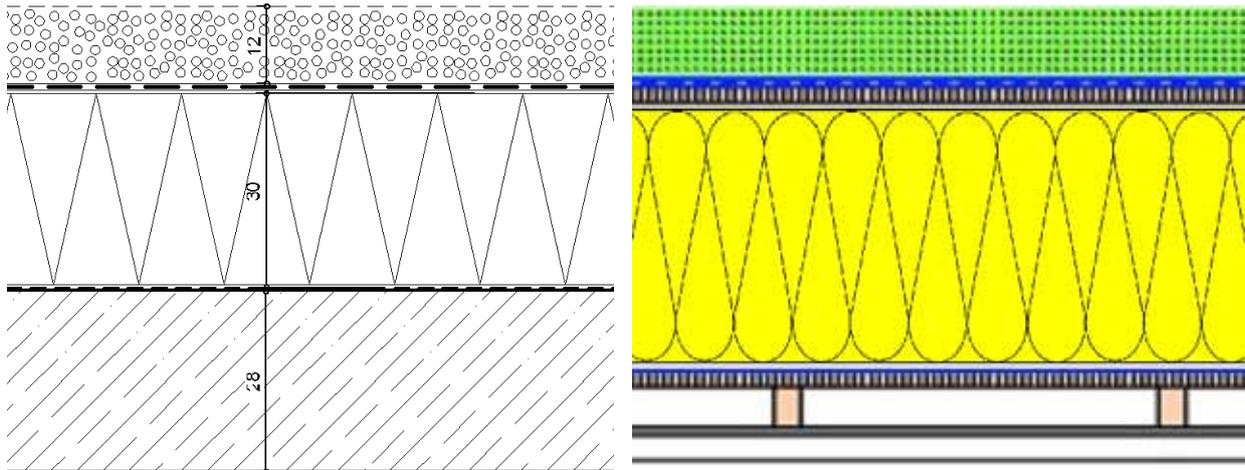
Links: Riedberg-Schule in Frankfurt. Nicht belüftetes Flachdach mit massiver Tragkonstruktion Quelle: 4A Architekten, Stuttgart. Rechts: Montessori-Schule in Aufkirchen. Nicht belüftetes begrüntes Flachdach mit leichter Tragkonstruktion und feuchteadaptiver Dampfbremse. (Quelle: Walbrunn Grotz Vallentin Architekten, Bockhorn, [AkkP 29])
